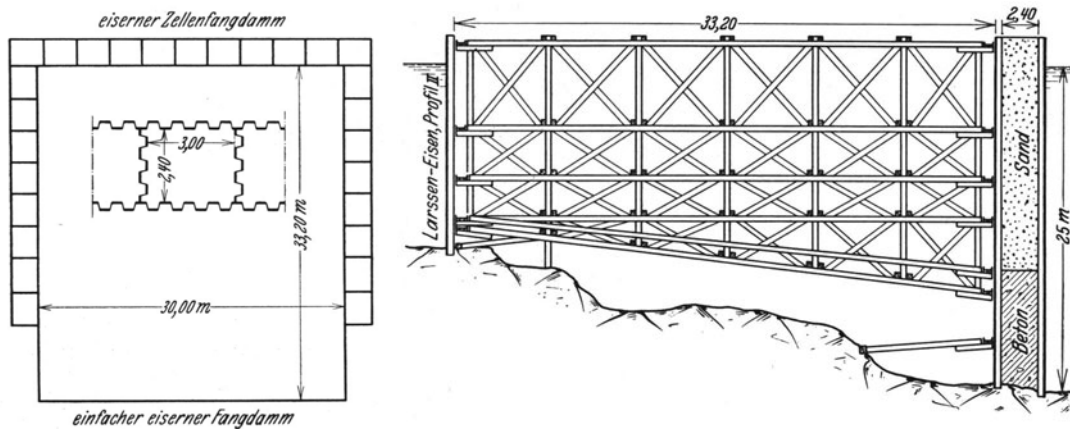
Grundriß einer Baugrube beim Bau des New Yorker Pfeilers der Hudsonbrücke. (Vereinigte Stahlwerke A.-G. Dortmunder Union.)
